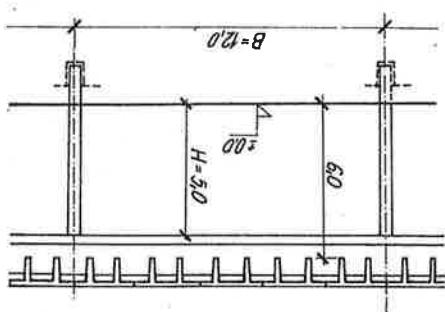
Příklad s výkladem parametrů phdorysné osnovy hal 18/12 m:
